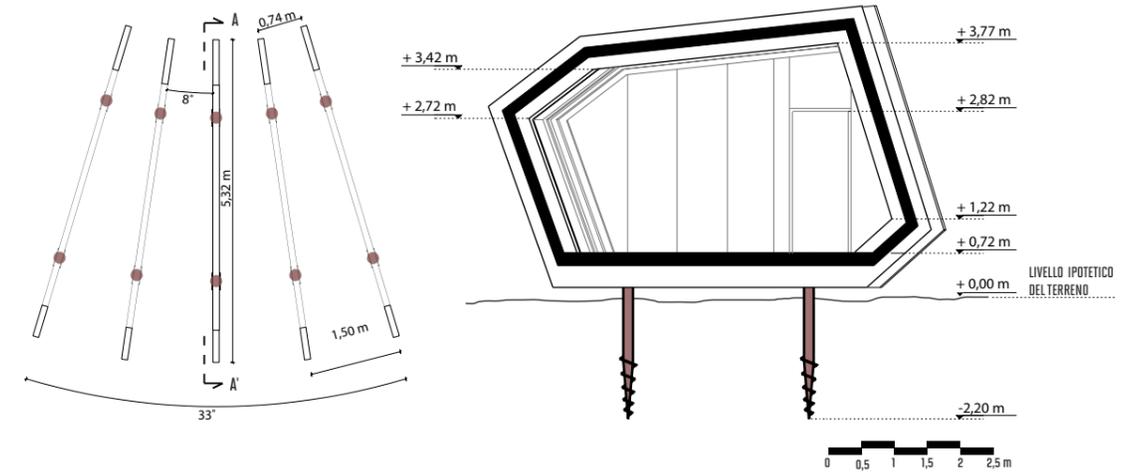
PLANIMETRIA DELLA FONDAZIONE VITE E SEZIONE AA'
